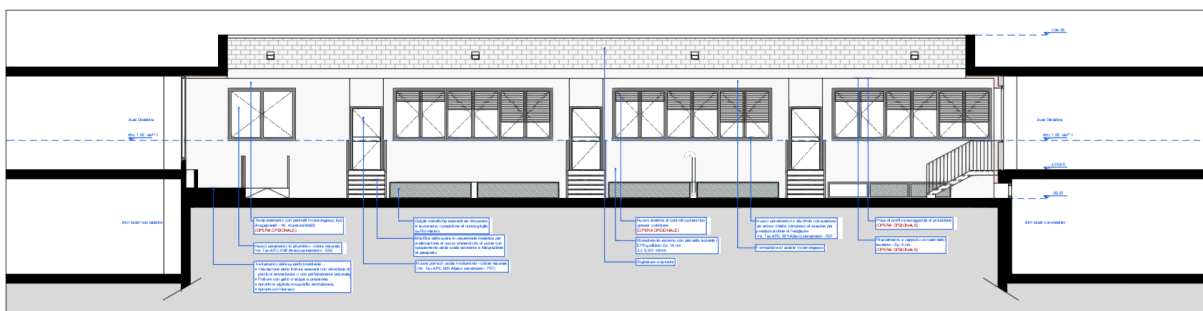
Prospetto interno a Ovest – Stato di Progetto
